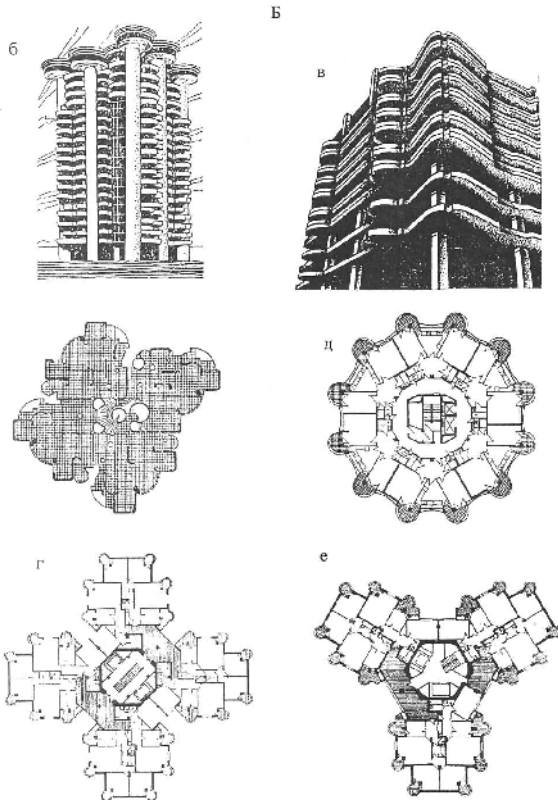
Односекционные многосторонние дома (продолжение); Б – примеры проектных решений: 6 – Мадрид, общий вид и план дома "Белые Башни", 7 – башня строительной системы М1 III (метод годьема перекрытий) в мозаике, 8 – башня типа "Крест", проект, 9 – Киев, план этажа дома "Ромашка", 10 – Ереван, план дома "Трилистник"
